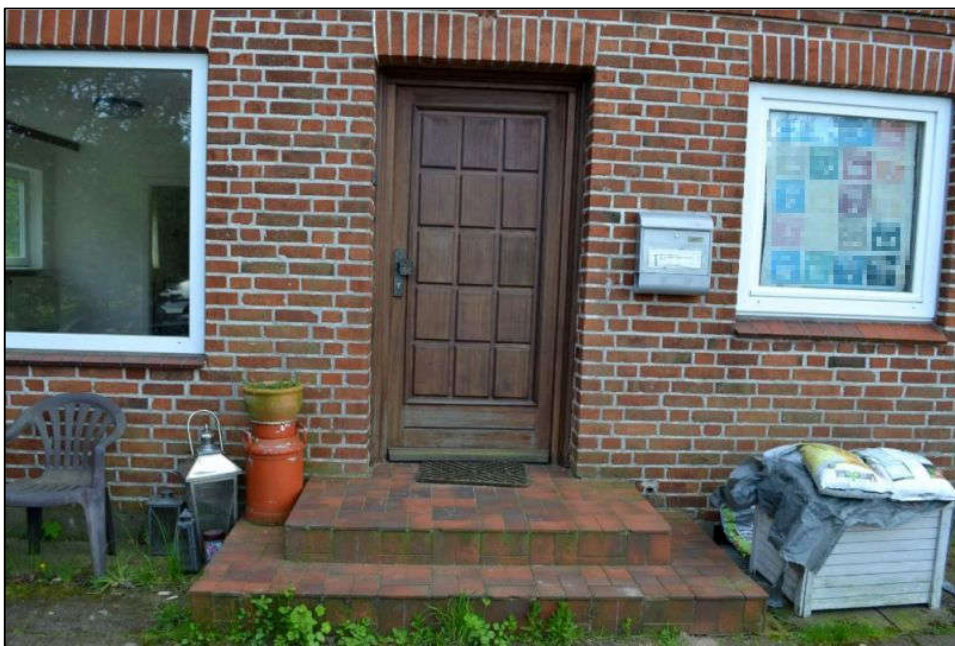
Hauseingang bzw. Treppenhauseingang (WE 1 und WE 2)
